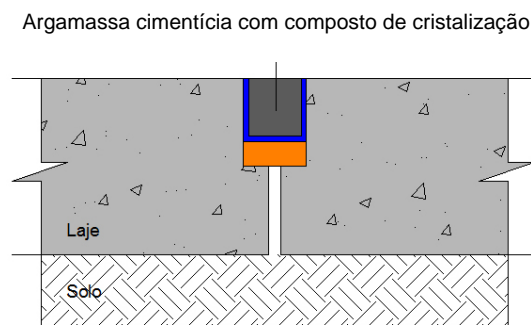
Tamponamento de furo da ponteira com argamassa de pega rápida e argamassa cimentícia com composto de cristalização.
